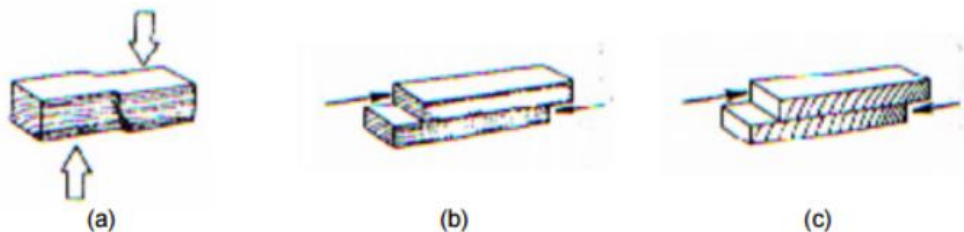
(a) Corte perpendicular as fibras; (b) corte paralelo ao plano das fibras; (c) corte transversal em relação ao eixo longitudinal. [4]
